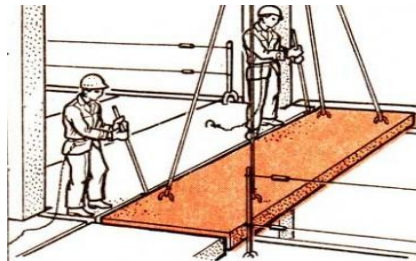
Наведение, ориентирование и установка плит перекрытия
